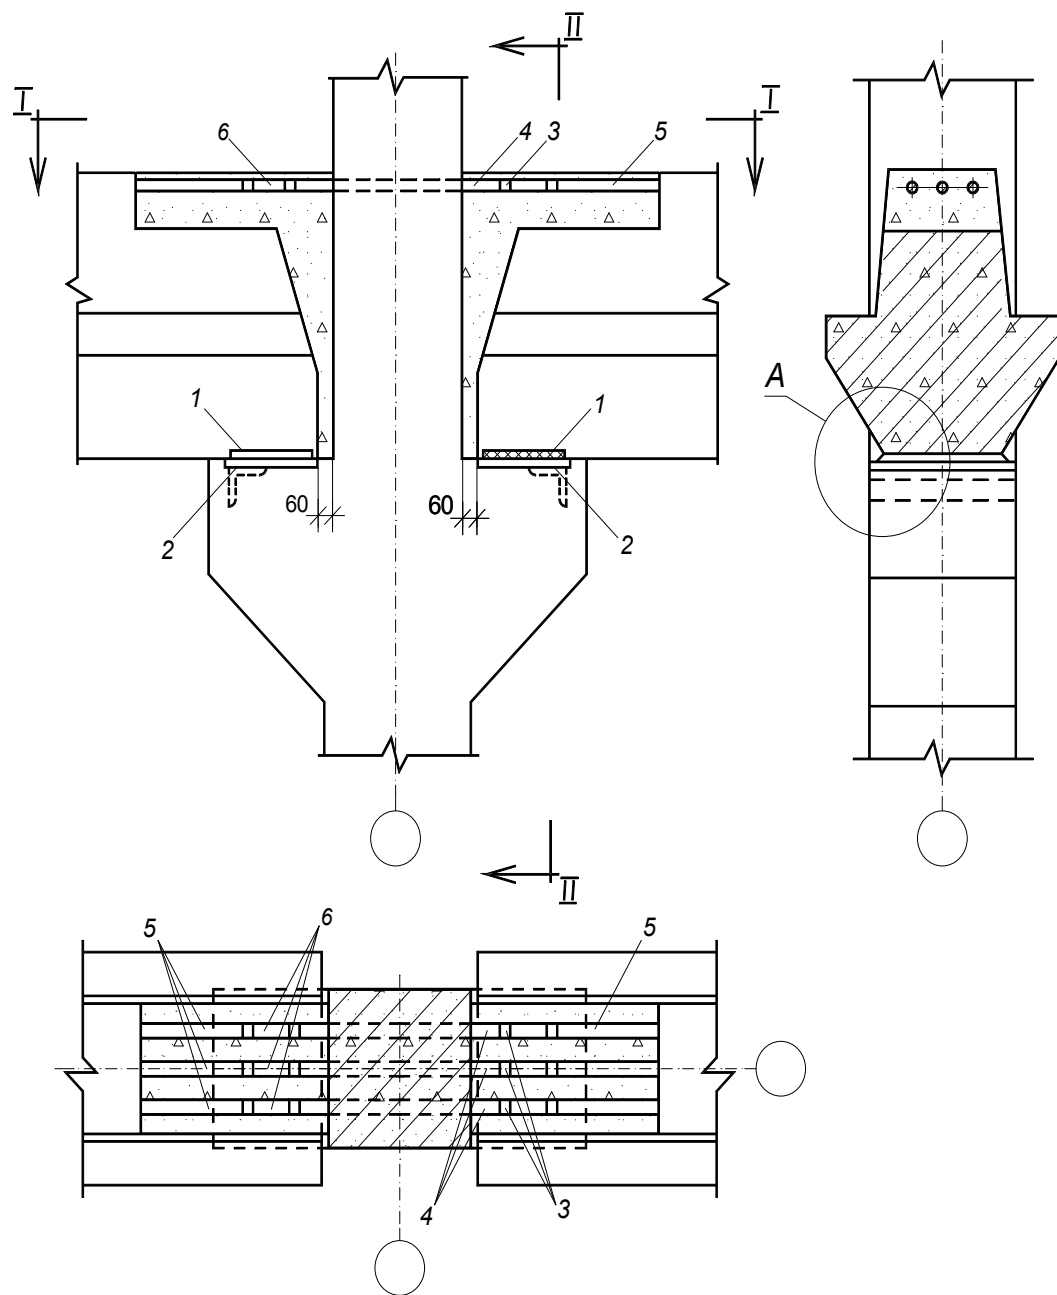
Деталі дотикання ригеля перекриття з середньою колоною при ригелях з полицями: 1 – закладні елементи ригеля; 2 – закладні елементи колони; 3 – ванне зварювання; 4 – випуск арматури колони; 5 – випуск арматури ригеля 6 – коротиж арматури для з'єднання стержнів колони зі стержнями ригеля
